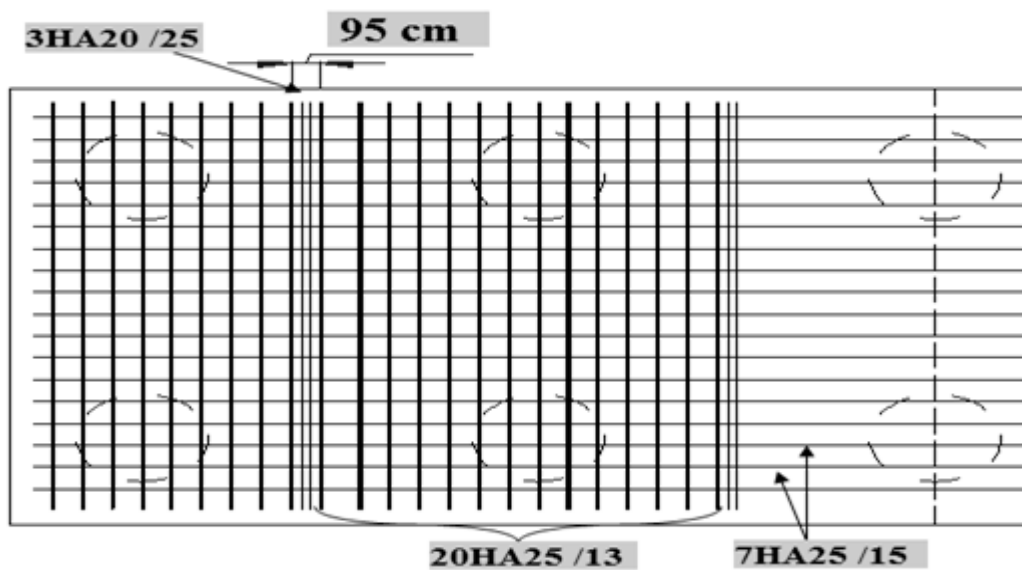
ferrailage de la semelle (nappe inférieure)
